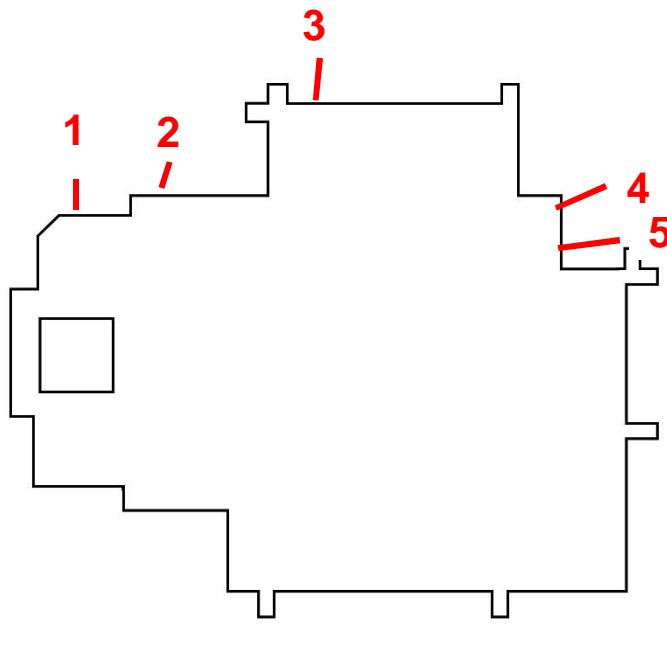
Grundrisschema der Kirche mit Lokalisierung der Messflächen
